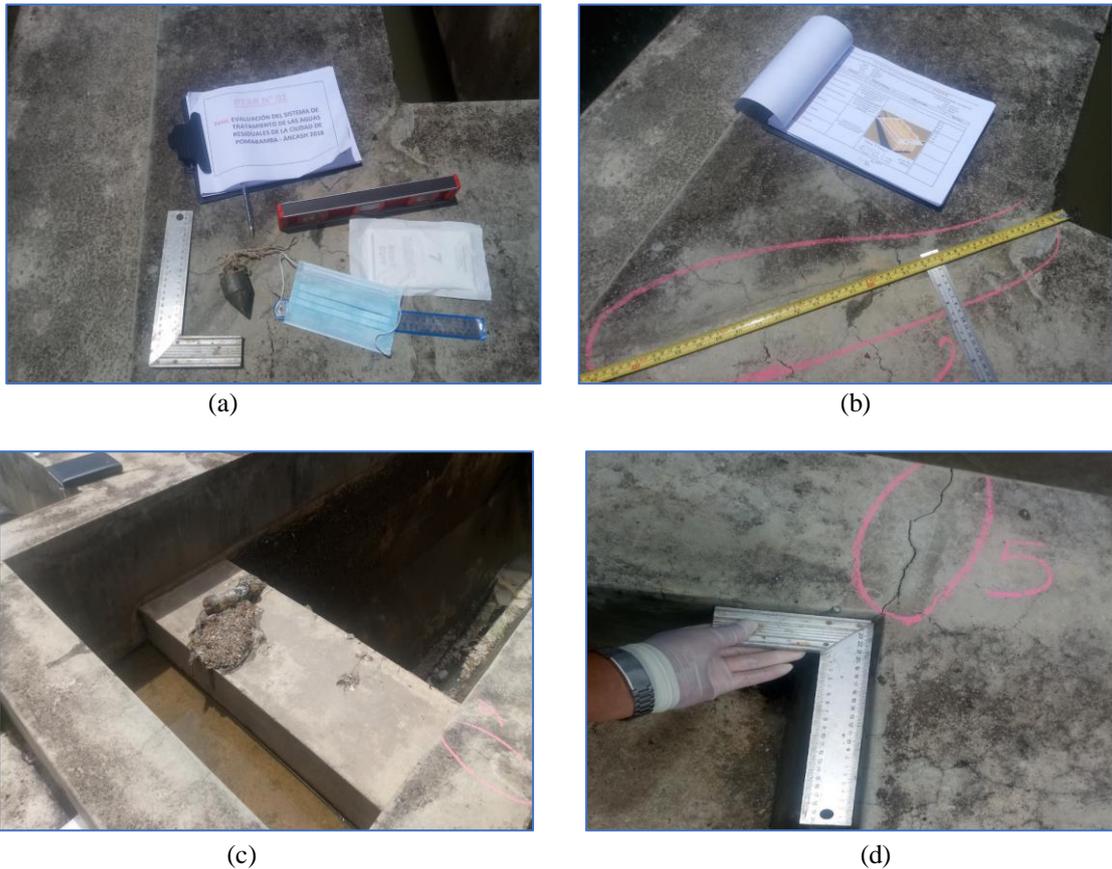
Vista de la Fisuras en el Tarrajeo
